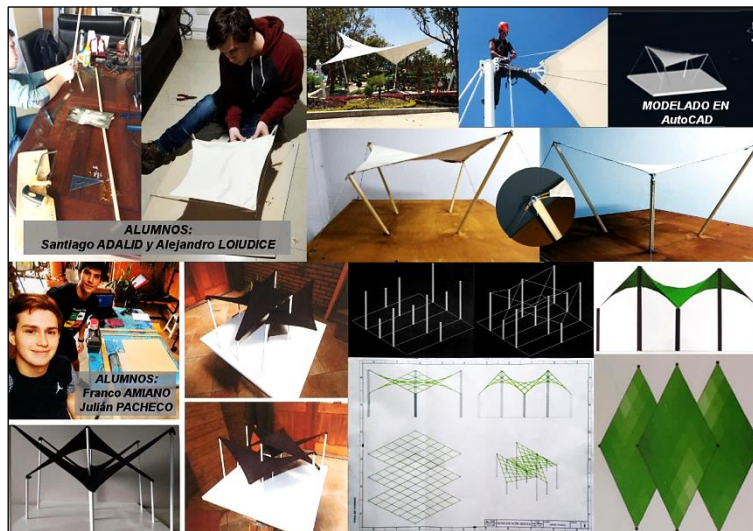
Tenso-estructuras textiles de forma paraboloides hiperbólicas.
